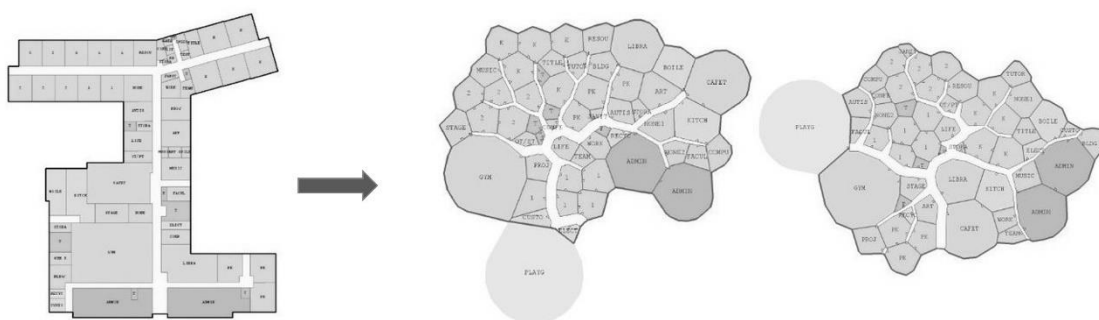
Evolving Floor Plans: Planta de uma escola reorganizada conforme otimização das zonas de distribuição. Créditos: Joel Simon
